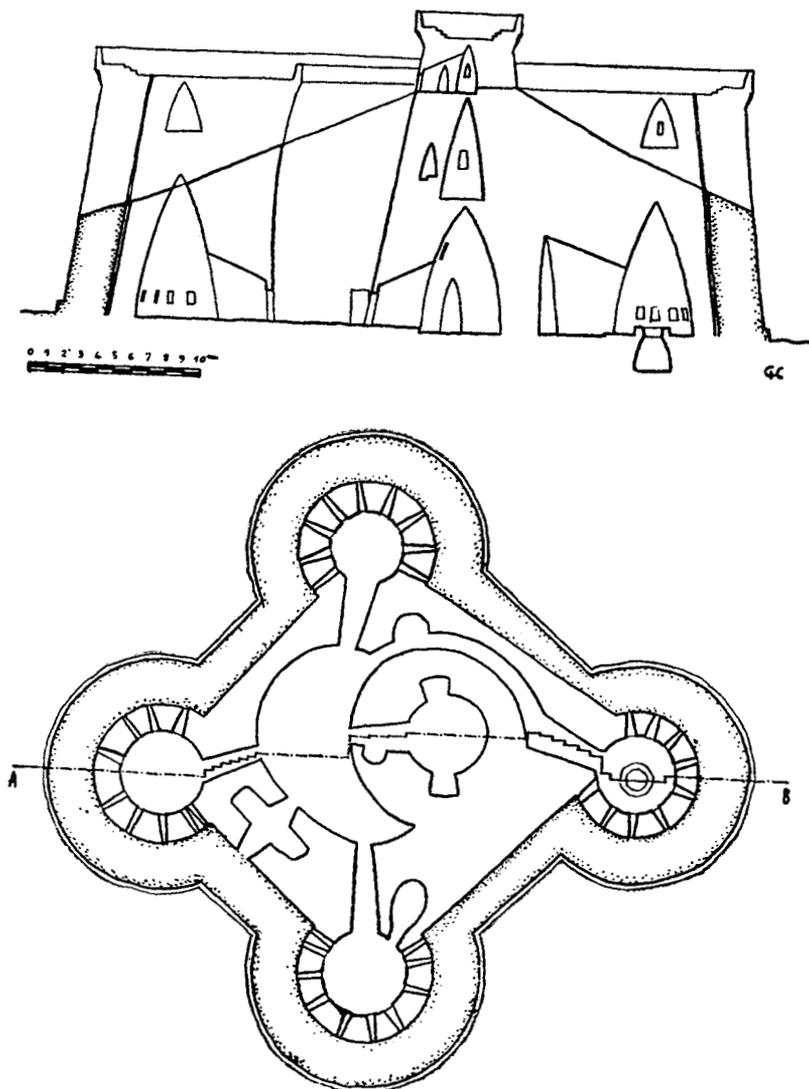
BARUMINI, *Su Nuraxi*: sezione e planimetria del nuraghe; (sezione sull'asse nord-sud) - Dis. dell'Arch. Guido Crudeli.
